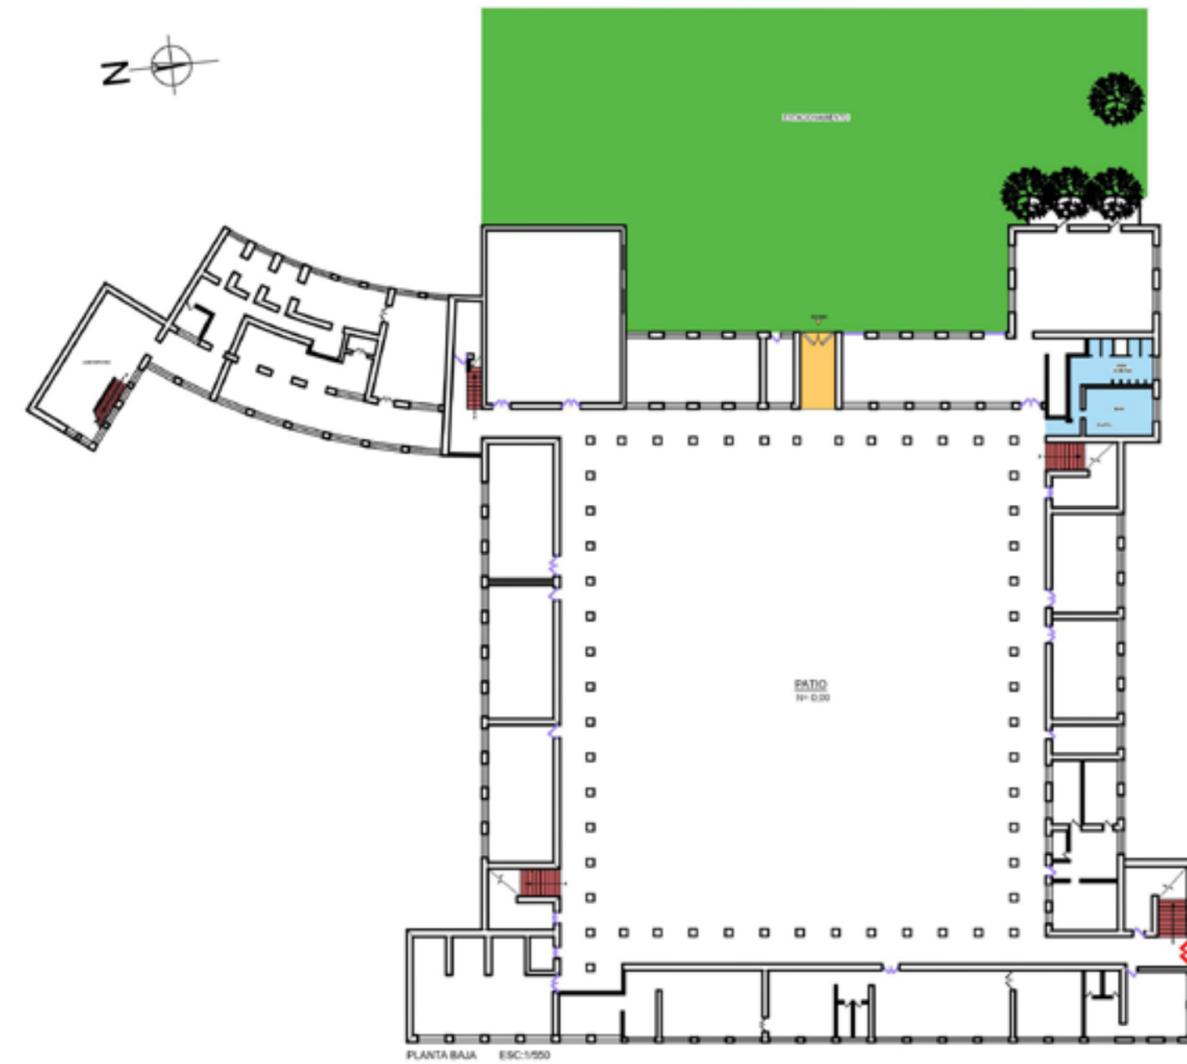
Condicionantes marcadas en la planta baja. Elaboración Propia (2021)
